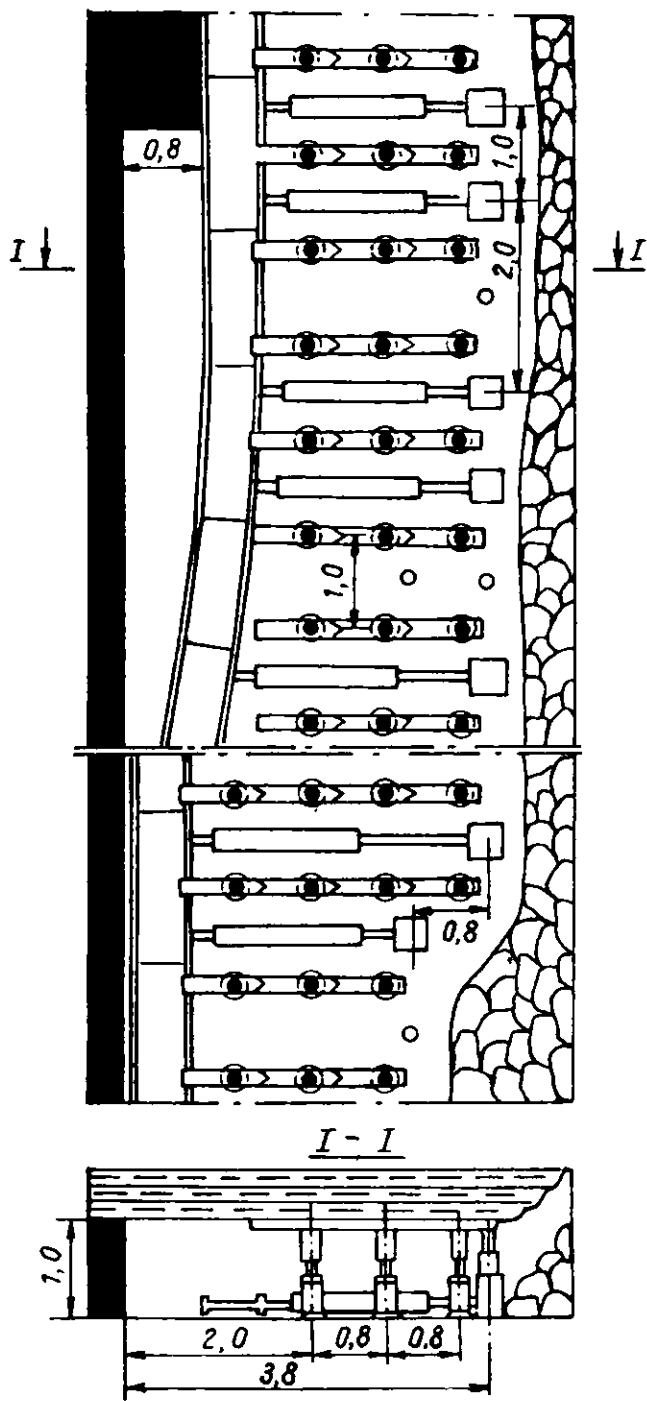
Схема крепления с установкой стоек индивидуальной крепи на опоры увеличенной площади
